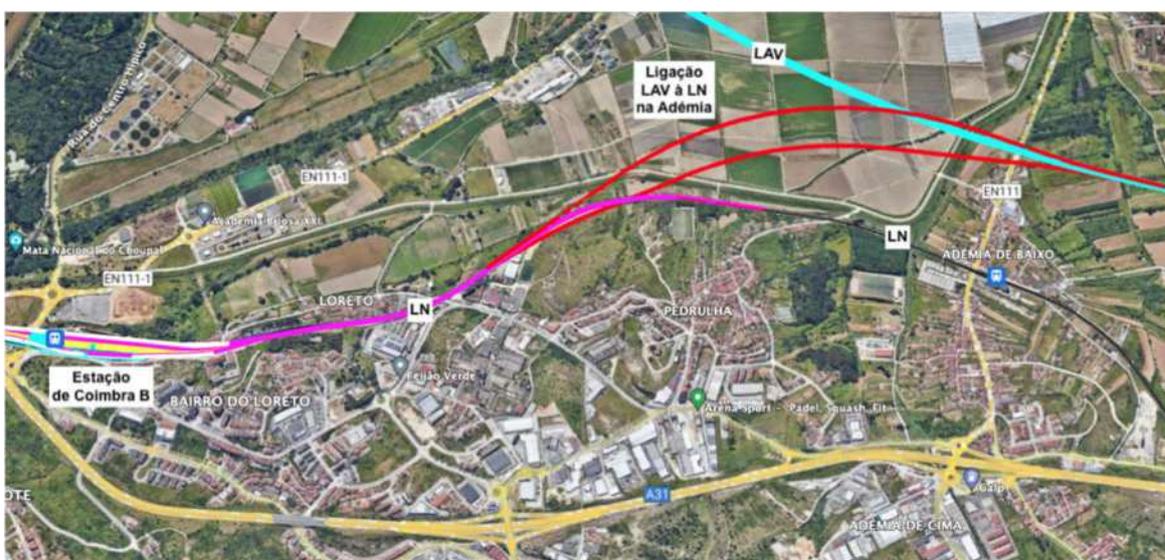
Ligação LN sul <=> LAV norte da Adémia
